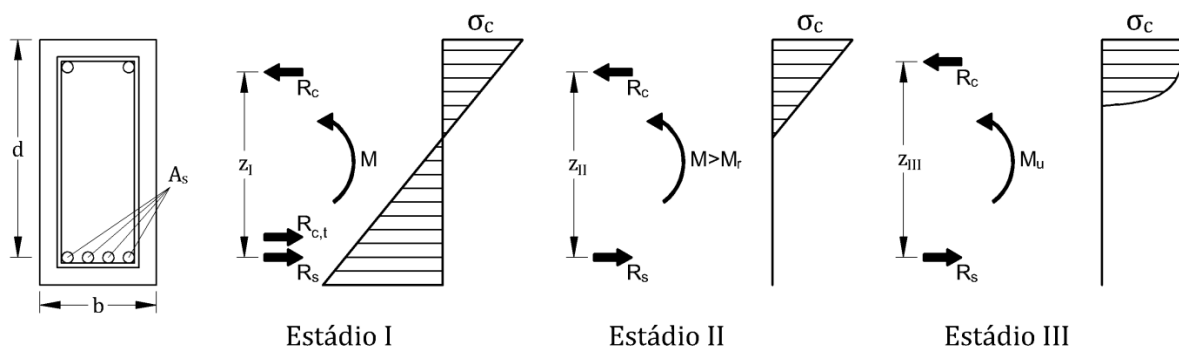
Comportamento da seção transversal de uma viga de concreto armado na flexão normal simples
